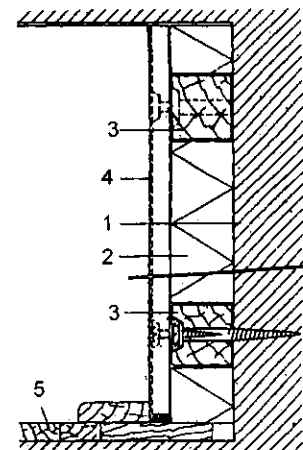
Вертикальный разрез конструкции дополнительного утепления изнутри помещения
